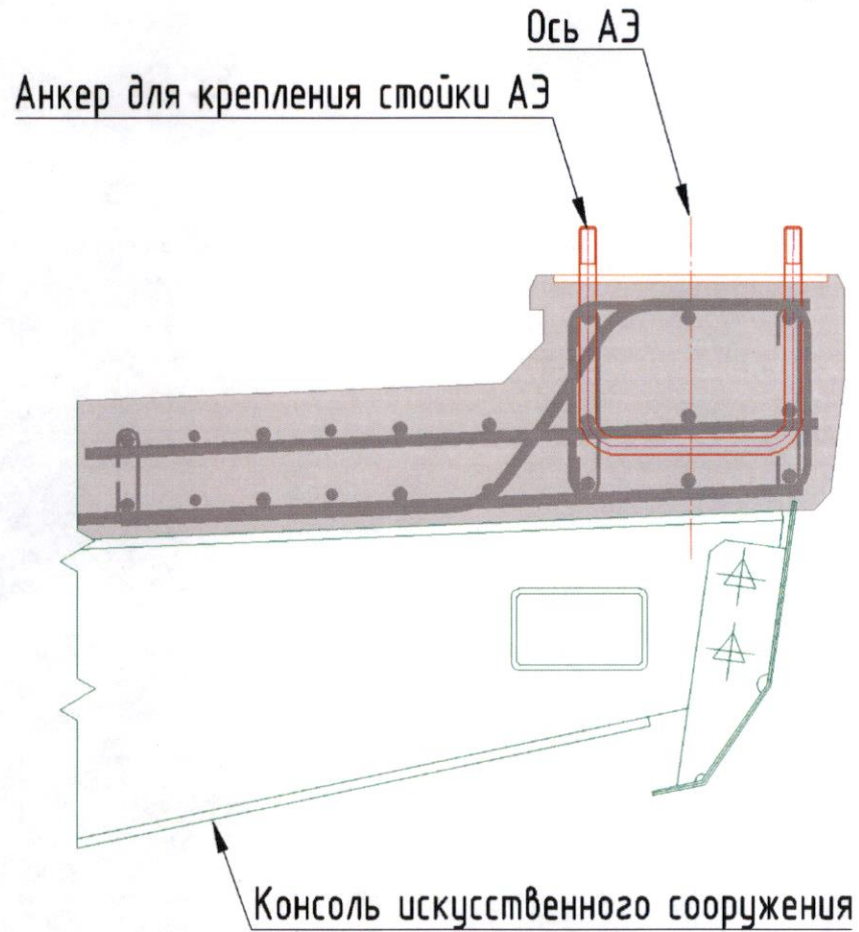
Узел для крепления стойки на железобетонной плите консоли
